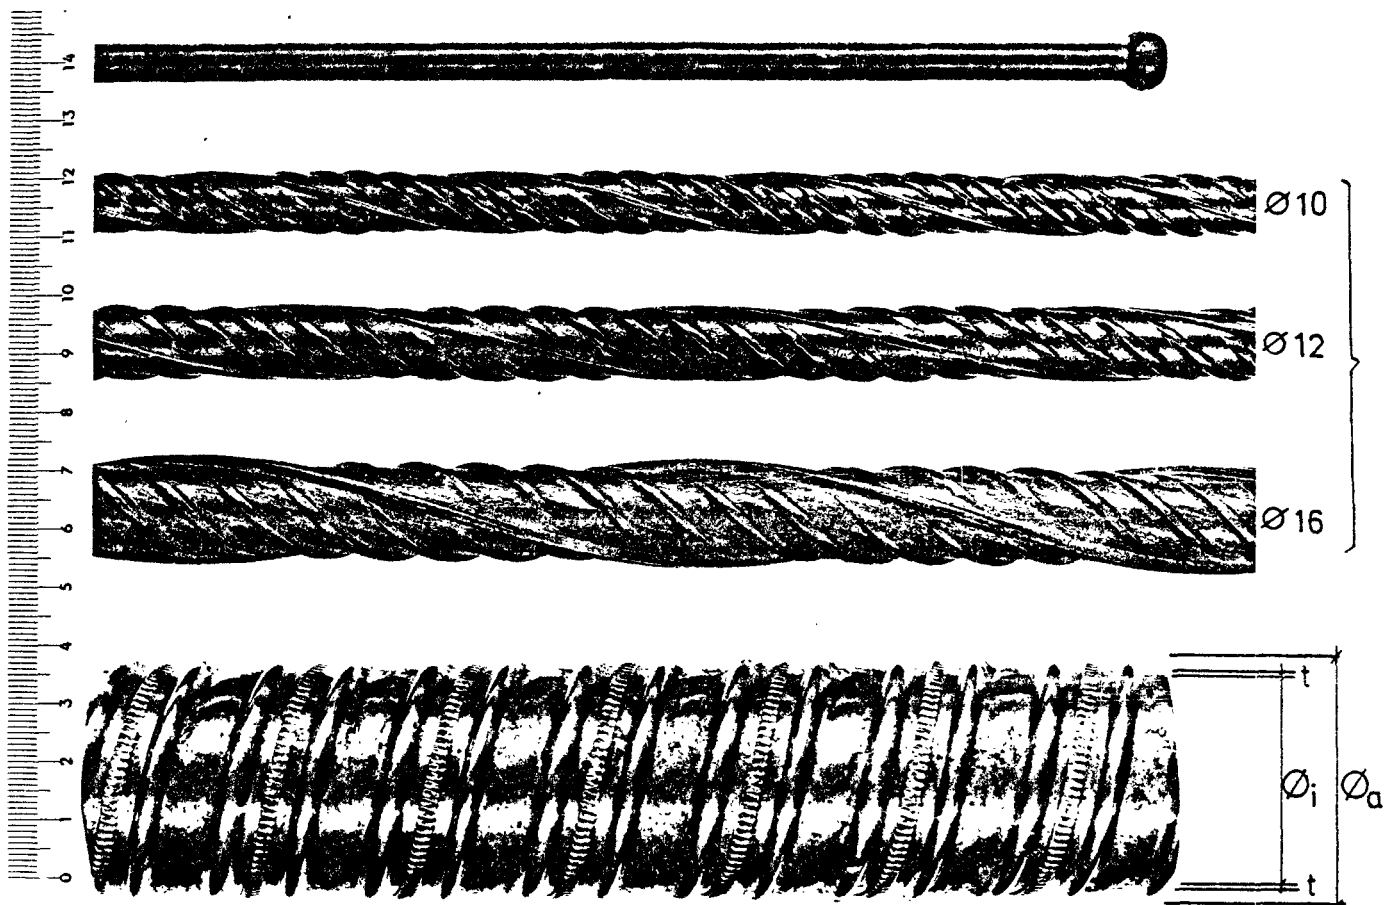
Spannstahl, Betonstähle und Hüllrohr
